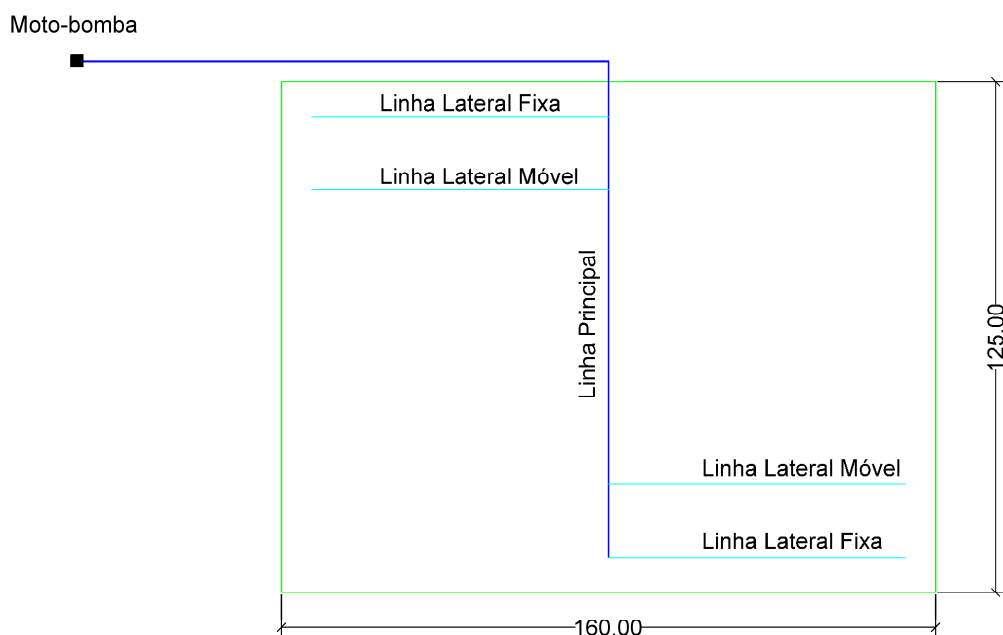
Layout do sistema de irrigação por aspersão convencional com linhas laterais fixas e móveis para uma área de 2,0 ha.
